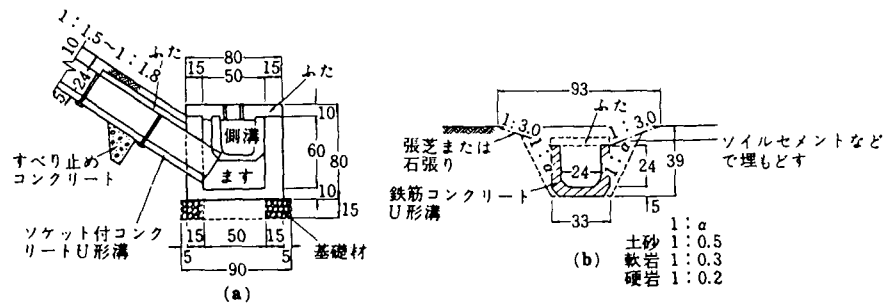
鉄筋コンクリートU字溝による縦排水溝の例 (単位cm)
